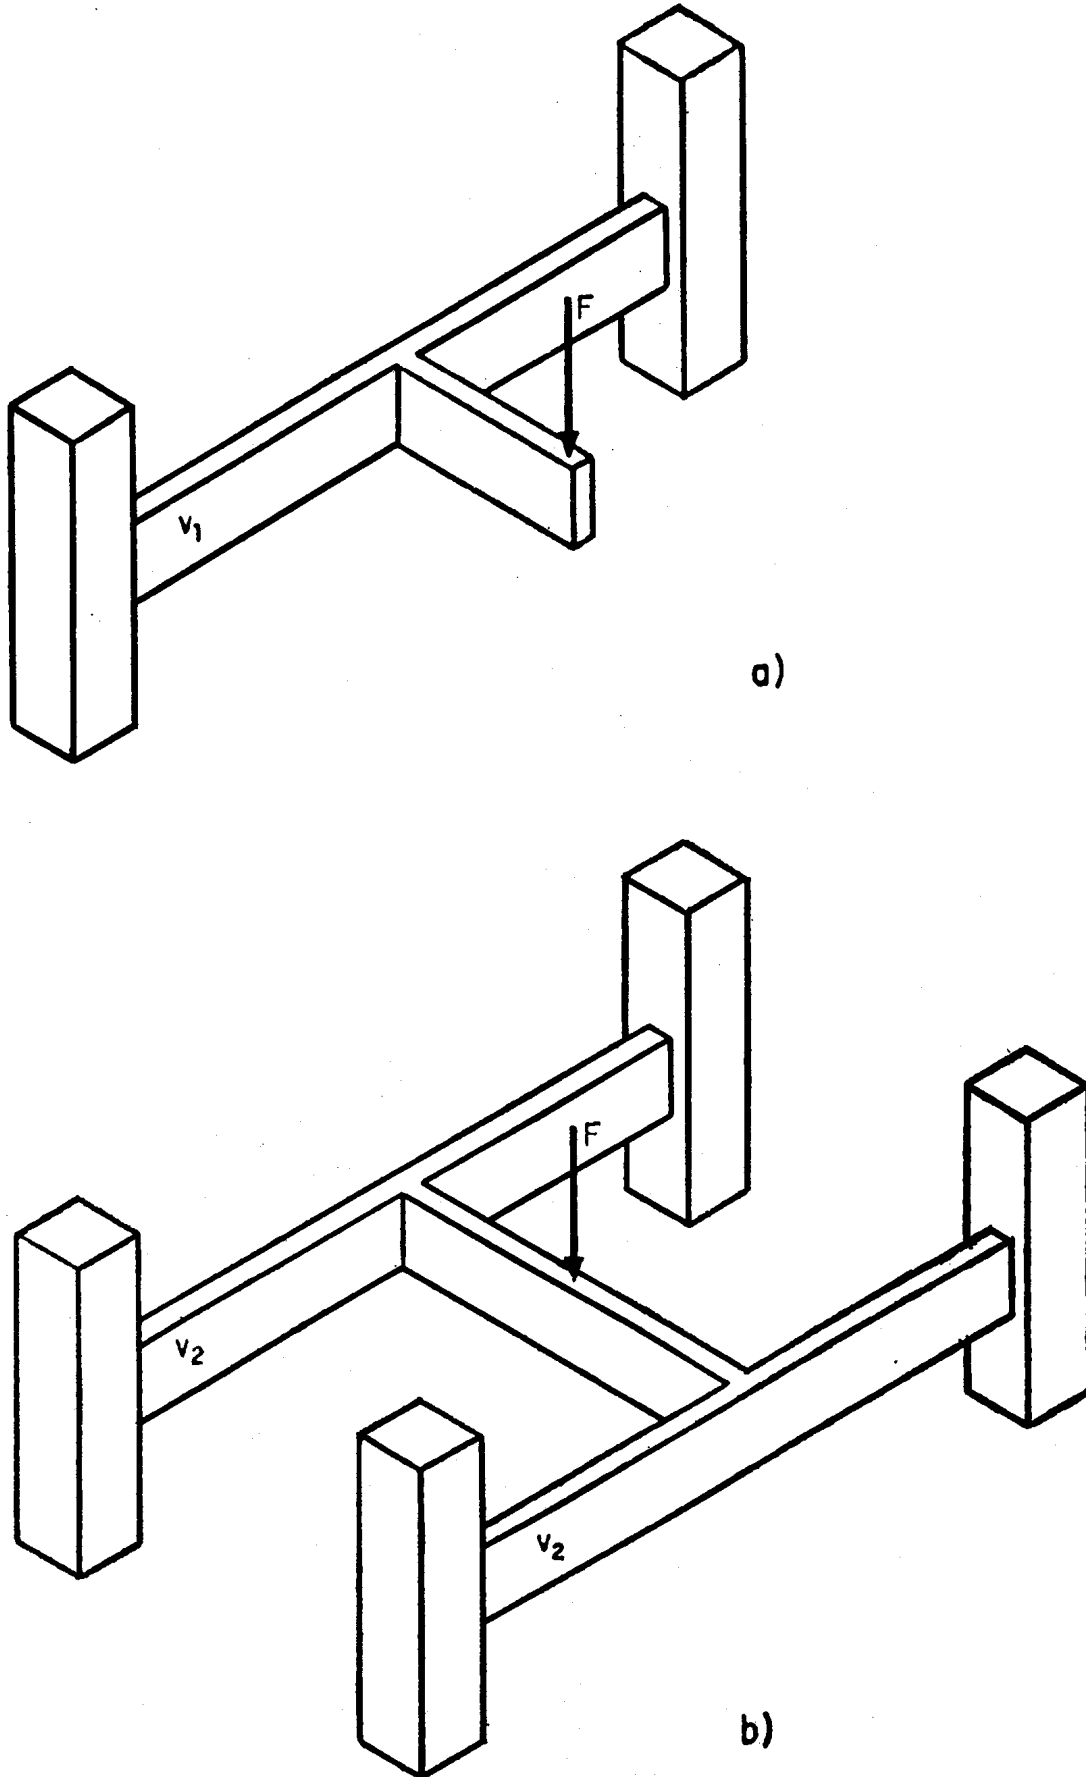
Ejemplos de vigas en las que existe torsión (vigas v_1 y v_2).
